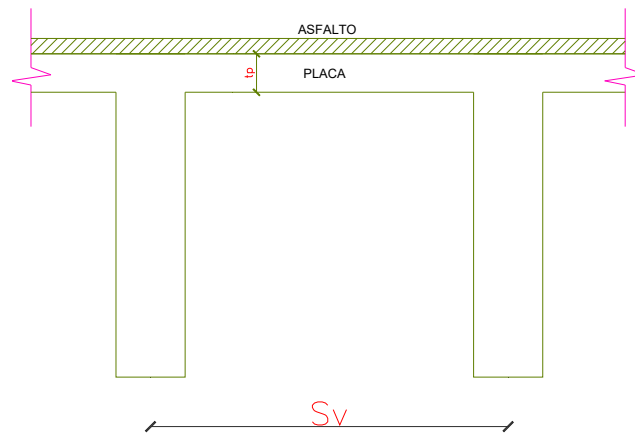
SECCIONES CARGA MUERTA PLACA ENTRE VIGAS. FUENTE: PROPIA
